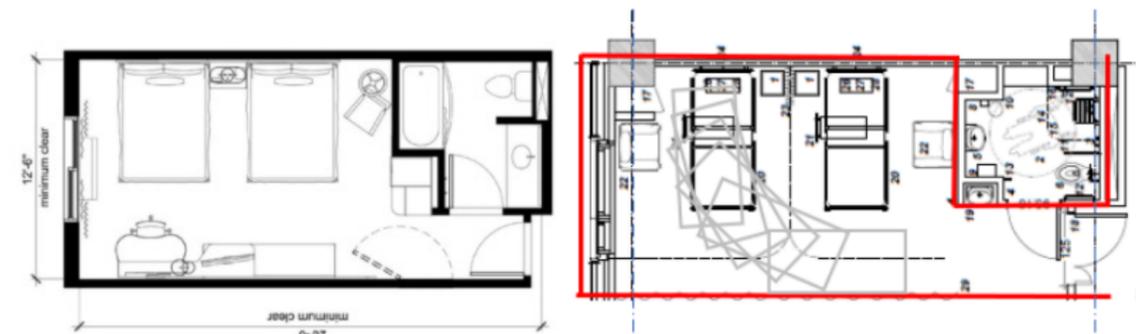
Planta tipo de Hotel. Fuente: 2D3D Floor Plan Company.
